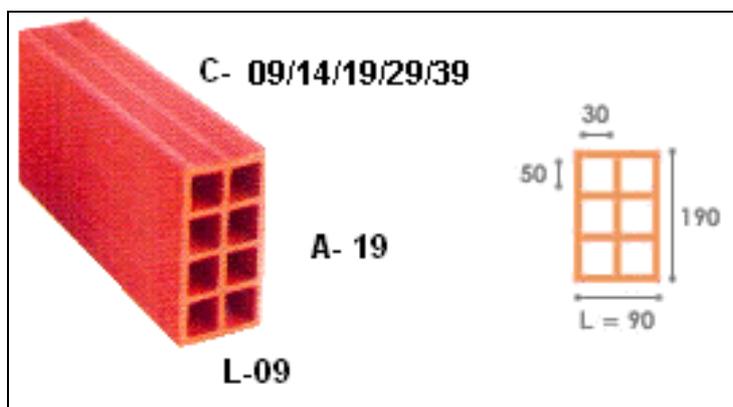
Tijolo cerâmico de vedação, com furos prismáticos horizontais (FK Comércio, 2008).
